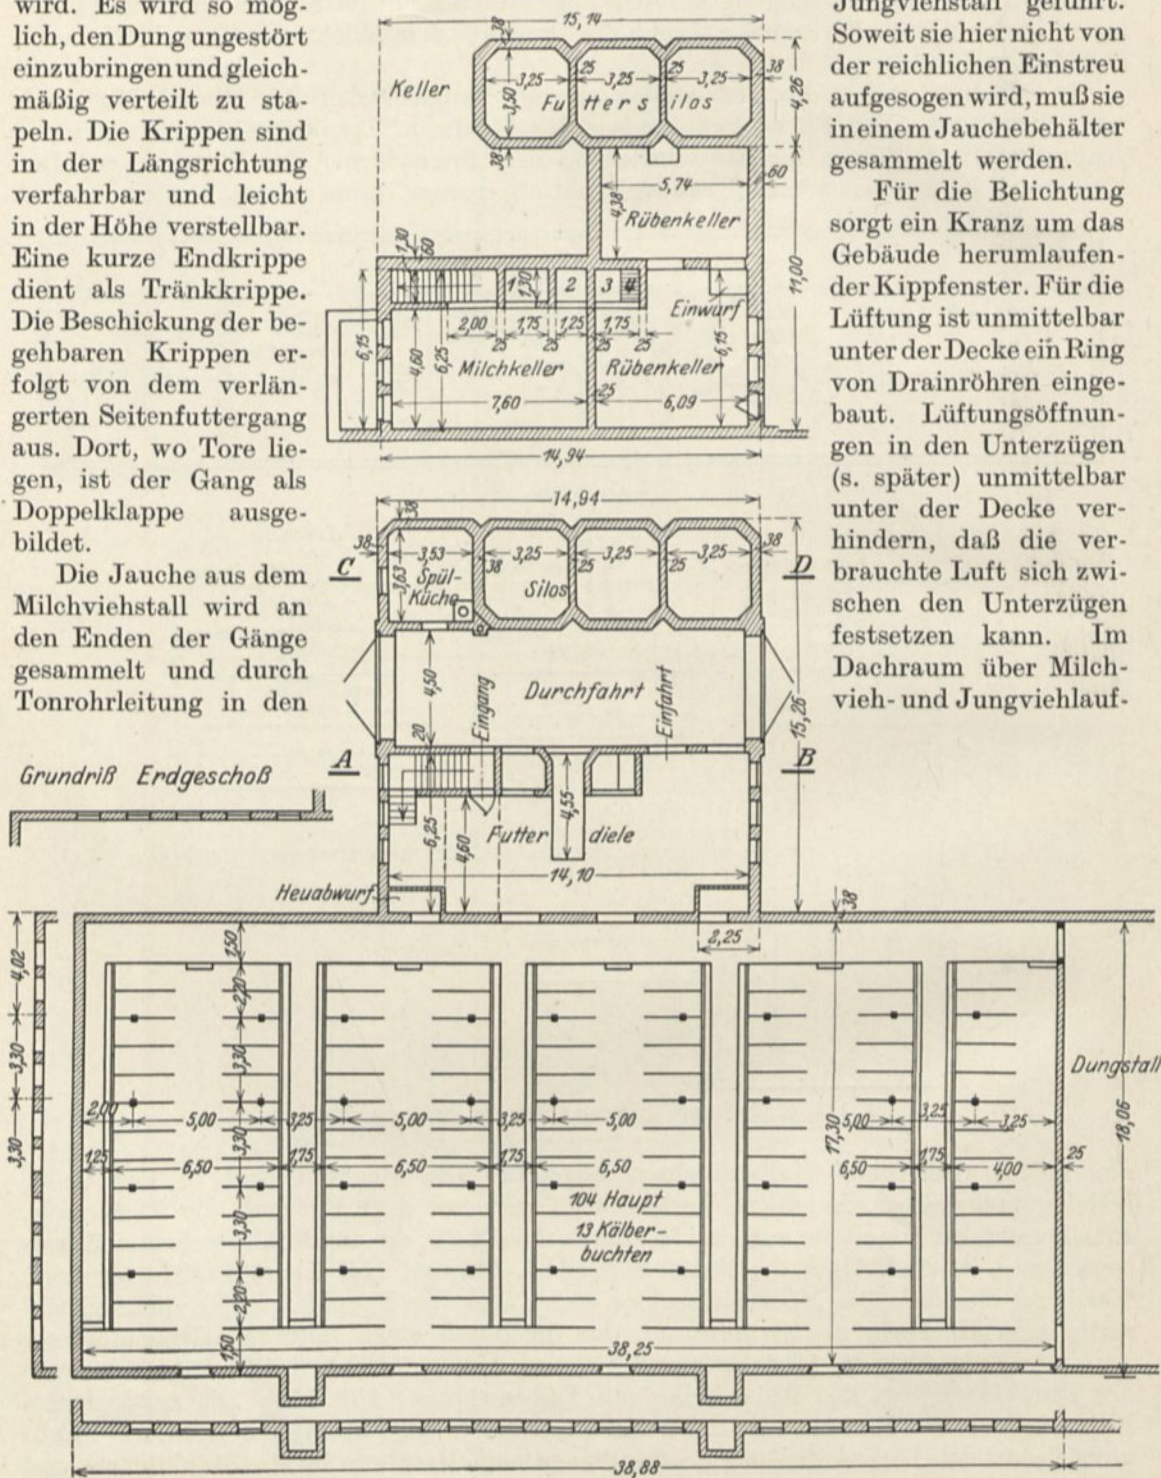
Viehstall Rittergut Cummerow (Bez. Regenwalde, Pommern). Grundriß, Erdgeschoß und Keller (des Vorbaues). (Ausführung: Hermann Scholl, Stettin.)
